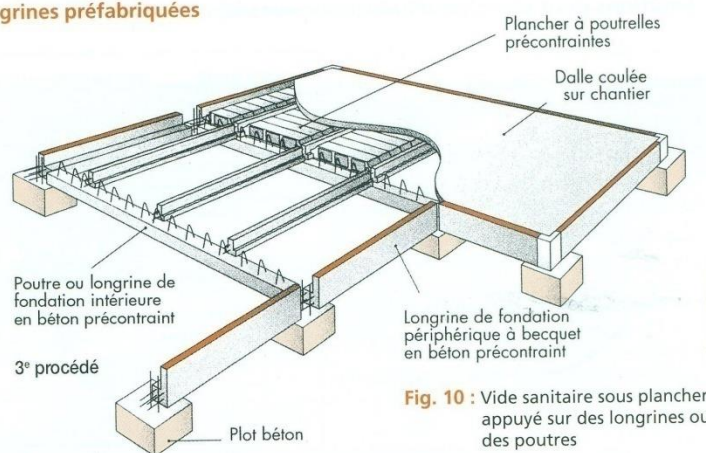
Vite sanitaire sous plancher appuyé sur des longrines ou des poutres
